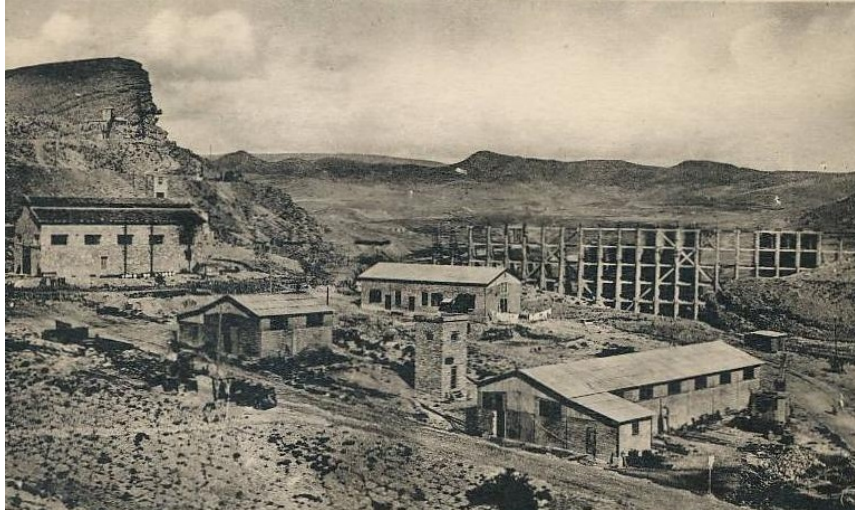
Vue sur le barrage K'sob lors de sa construction.
